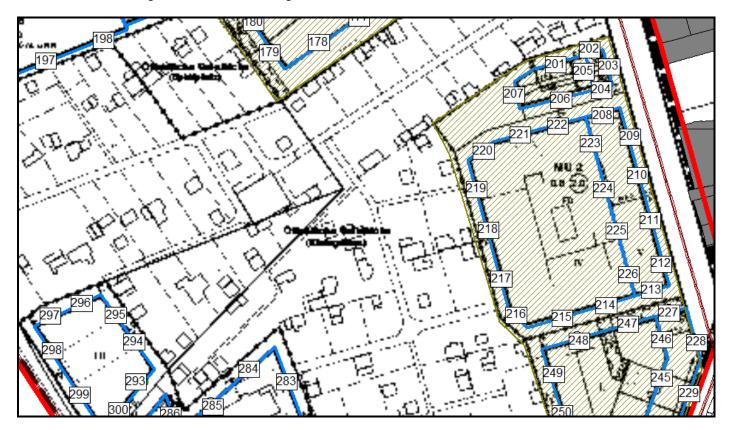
Lage und Nummerierung der Fassadenabschnitte
